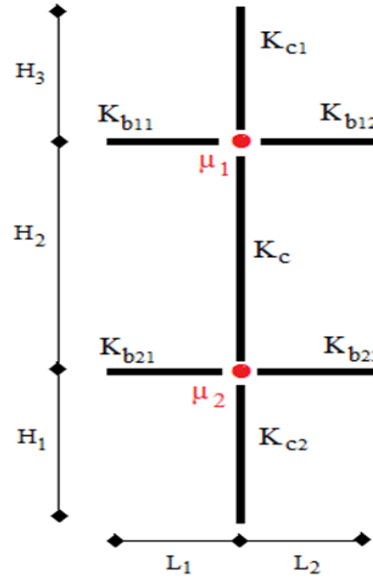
La rigidité (ou raidisseur) du poteau concerné.
